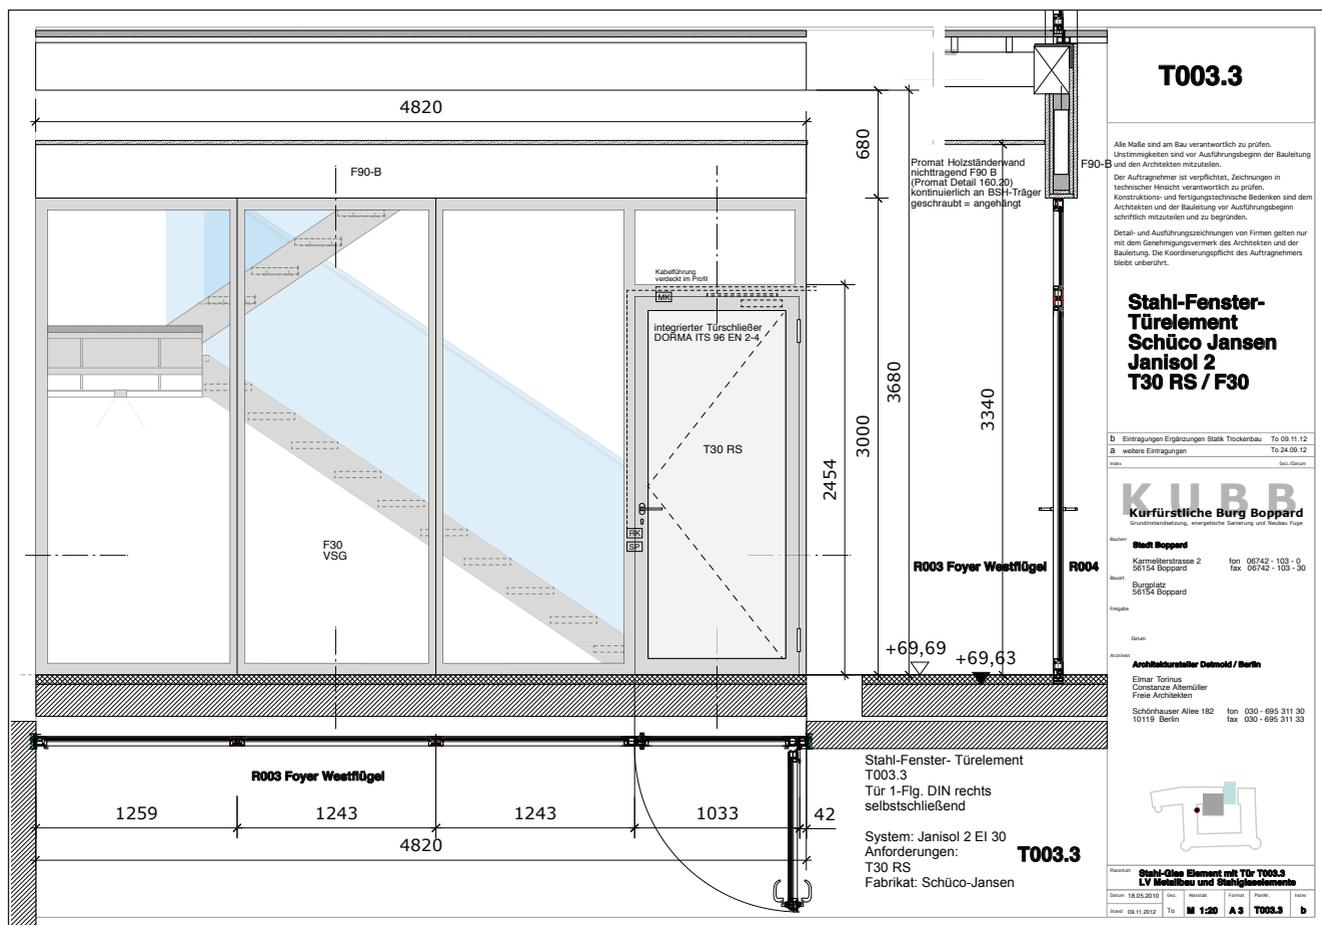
Detail T003.3, Darstellung des Stahl-Fenster-Türelements im Foyer der Erdgeschossstreppe West.
